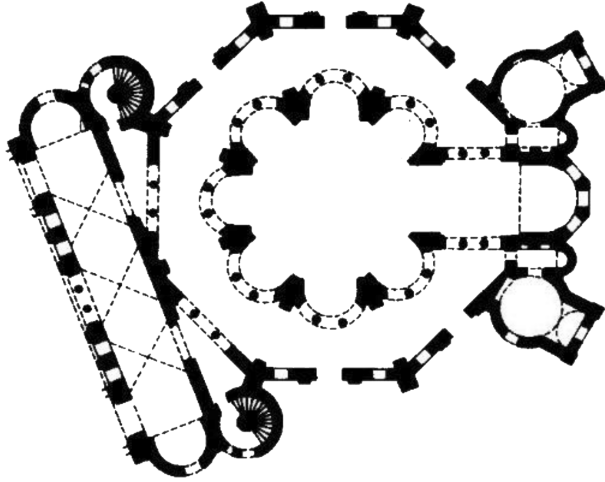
Ravenna, San Vitale, Grundriss
